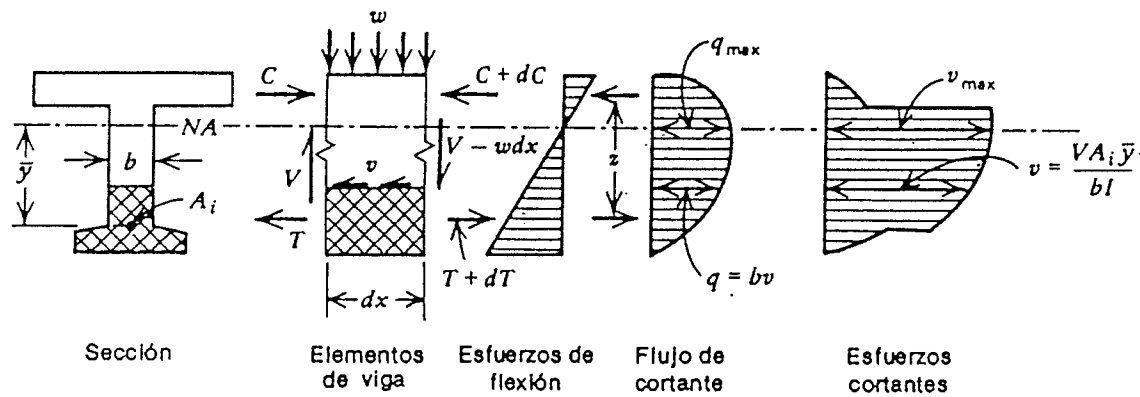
Esfuerzos de flexión y cortante en una sección no fisurada.
